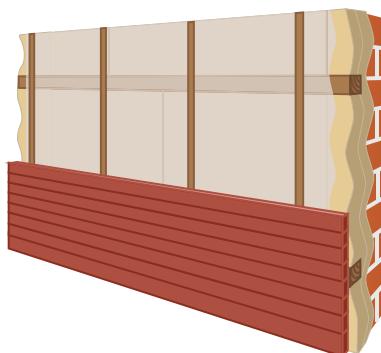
Монтаж теплоизоляционных плит в горизонтальный каркас
